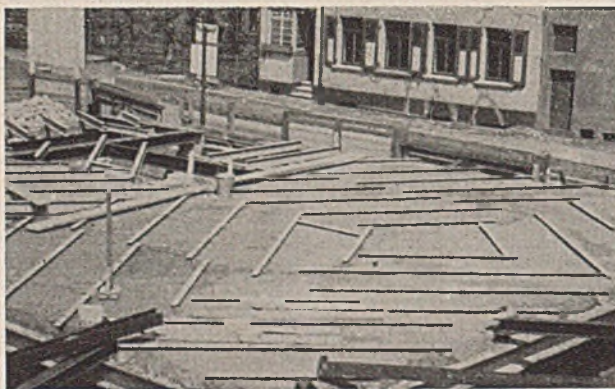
Kellerdecke während der Betonierung. Man beachte die Bergschäden an dem Hause im Hintergrunde.
